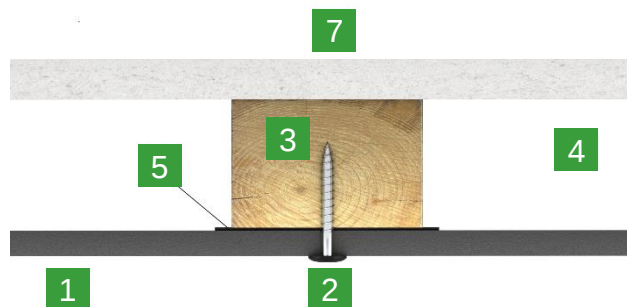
Sección horizontal. Apoyo intermedio.
